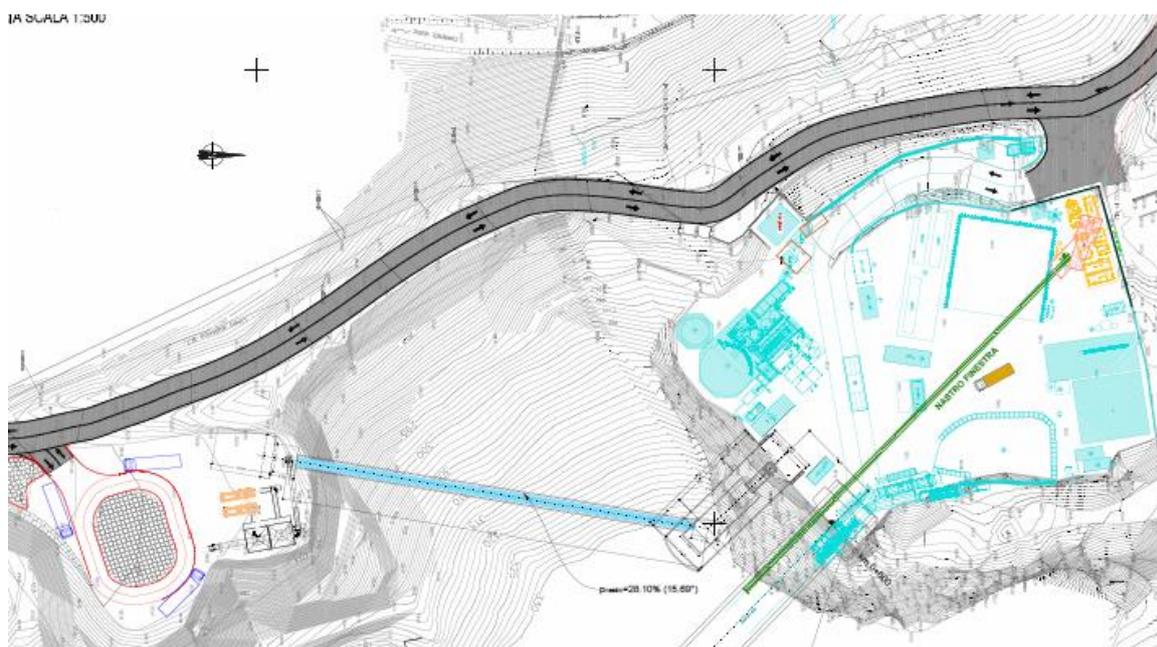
Planimetria Cantiere di Servizio Cravasco
